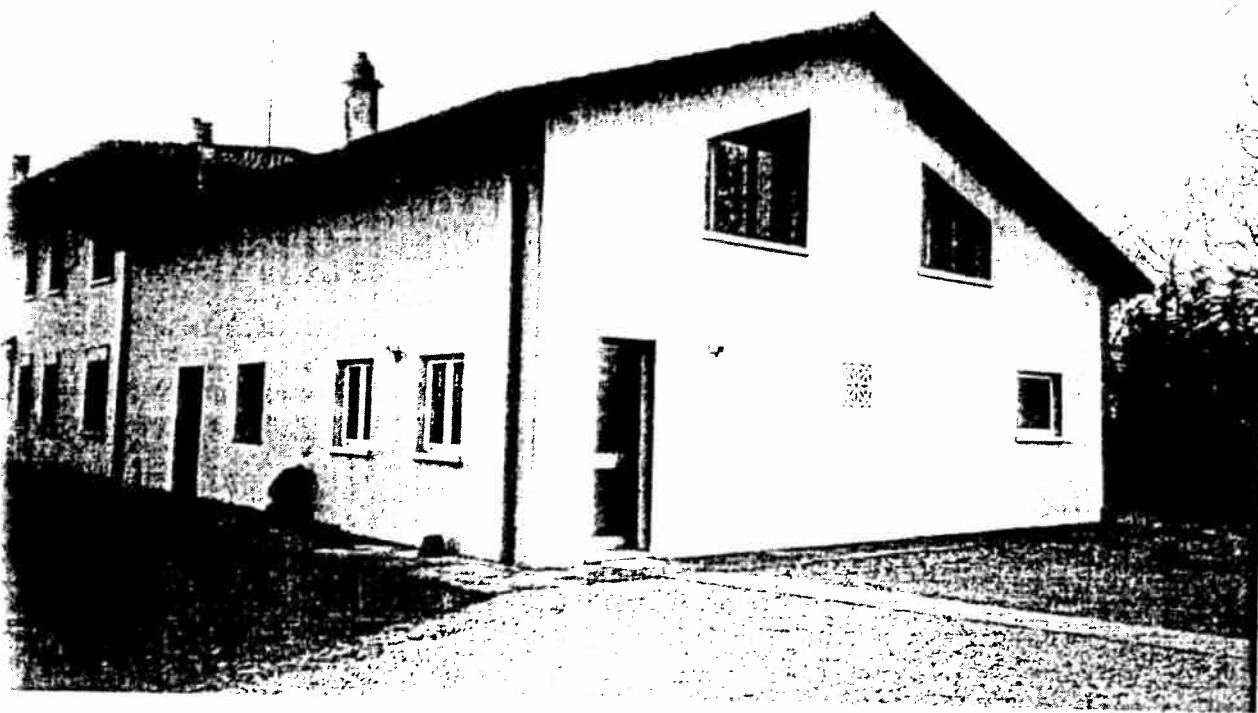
Prospetti lato nord ed est dell'abitazione
